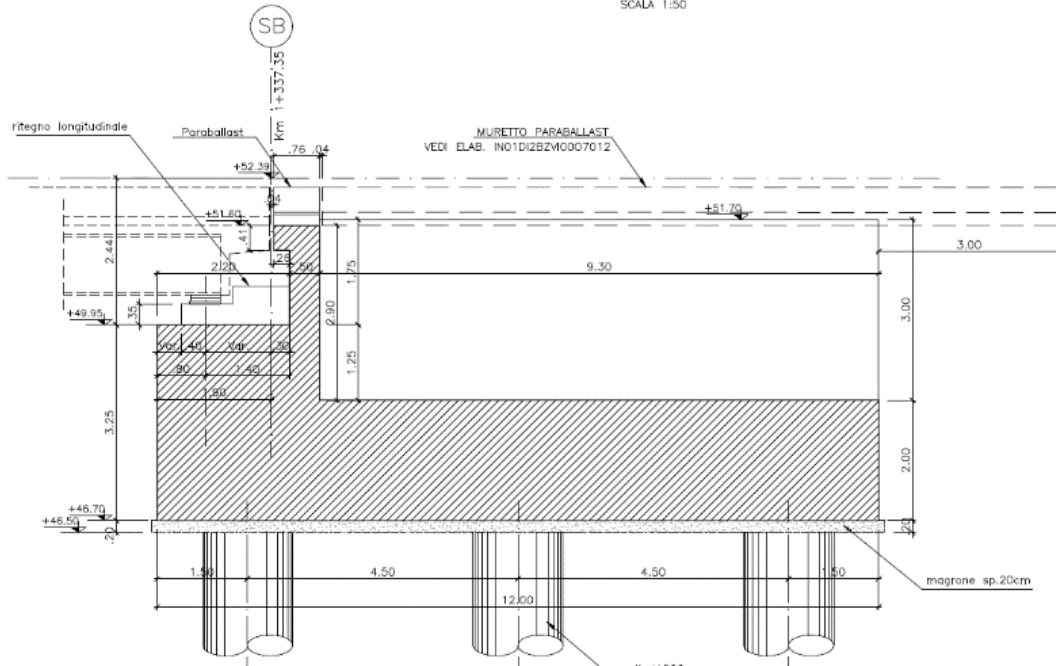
Sezione longitudinale Spalla B
